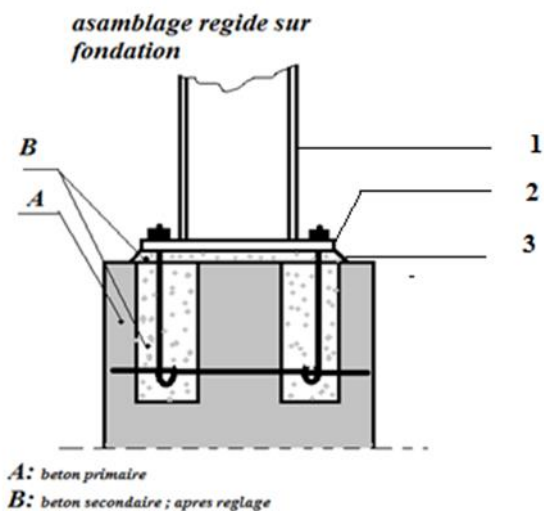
Assemblage des pieds de poteaux (HEA300)
